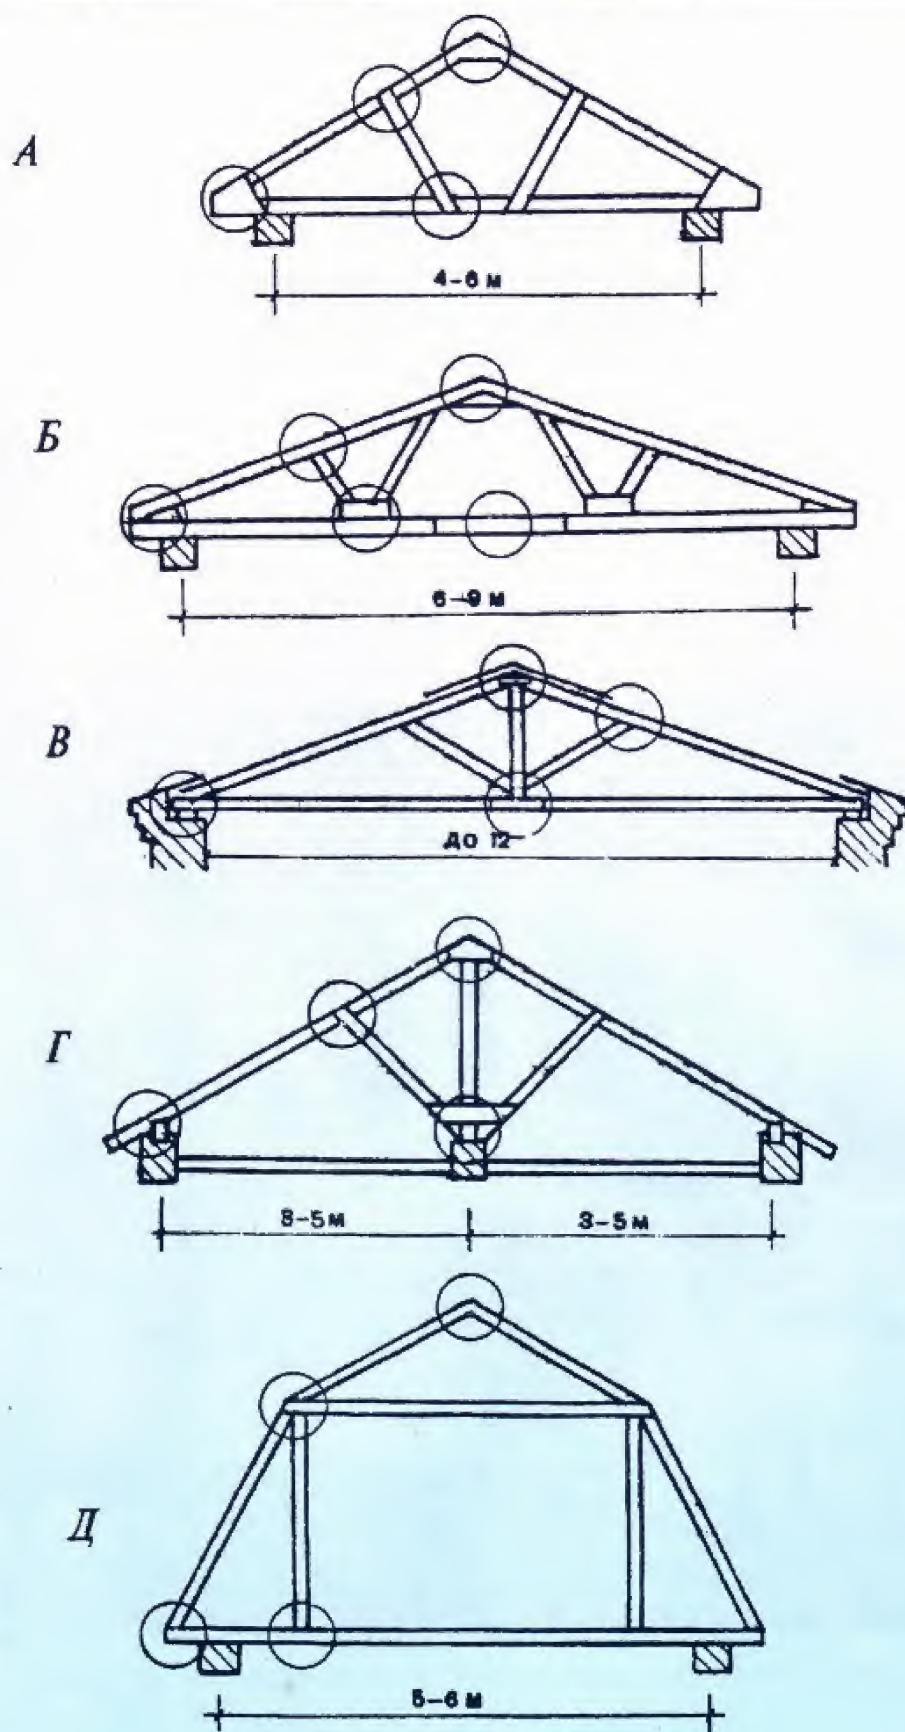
Крокв'яні ферми: А – висяча ферма однопрогінного будинку; Б – ферма з підкосами; В – ферма для однопрогінного будинку більше 8 м; Г – похила крокв'яна ферма; Д – ферма для мансардного даху.
